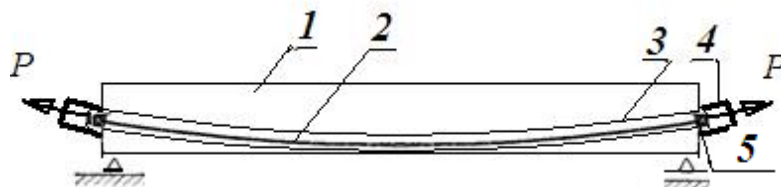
Схема армирования балок с натяжением арматуры после бетонирования
